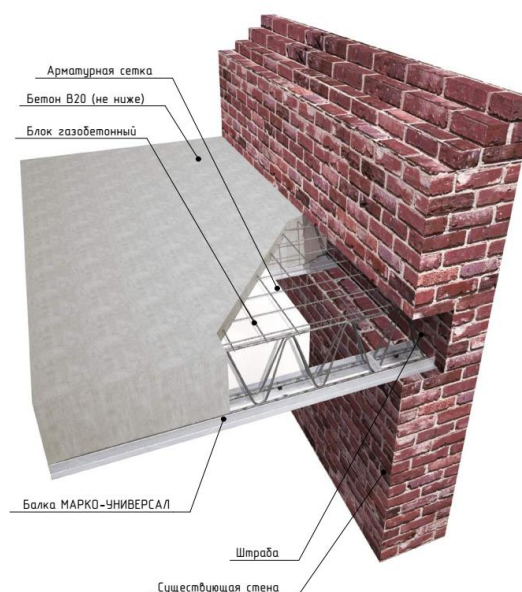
Вузол обпирання перекриття на існуючу несучу стіну при реконструкції перекриття
